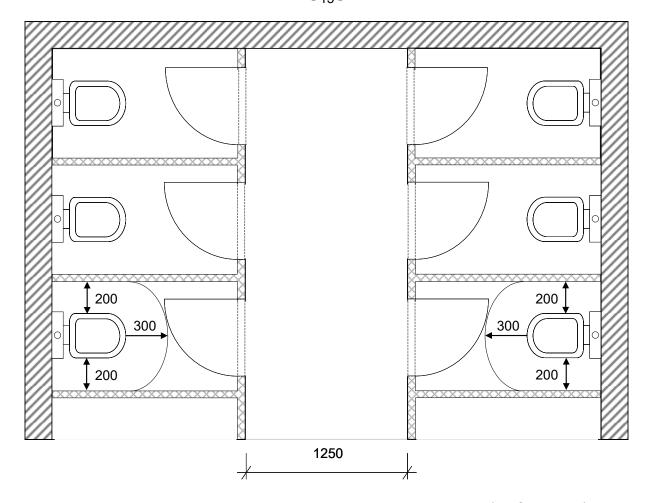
Zweibündige Toilettenanlage, Türanschlag nach innen (Maße in mm)
